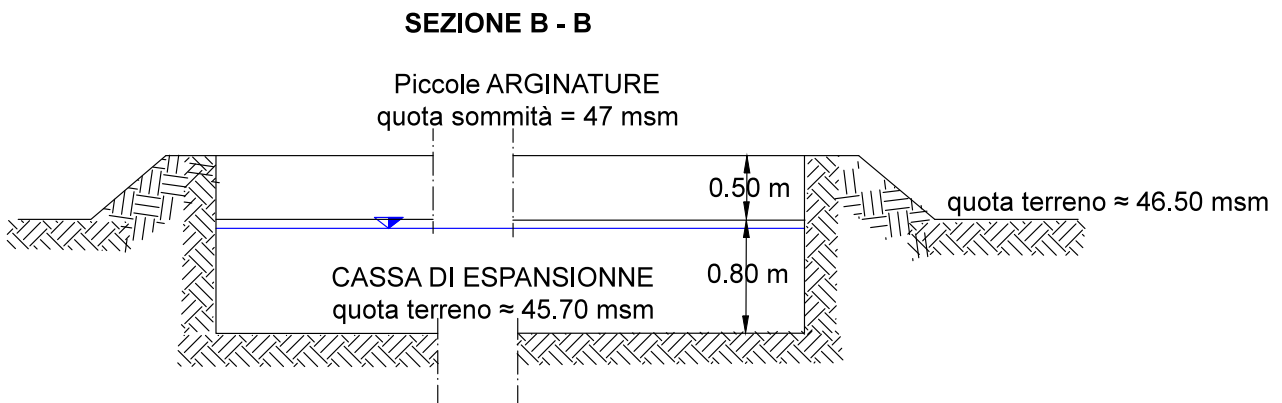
Sezione B-B con indicazione della cassa di espansione e delle piccole arginature.
